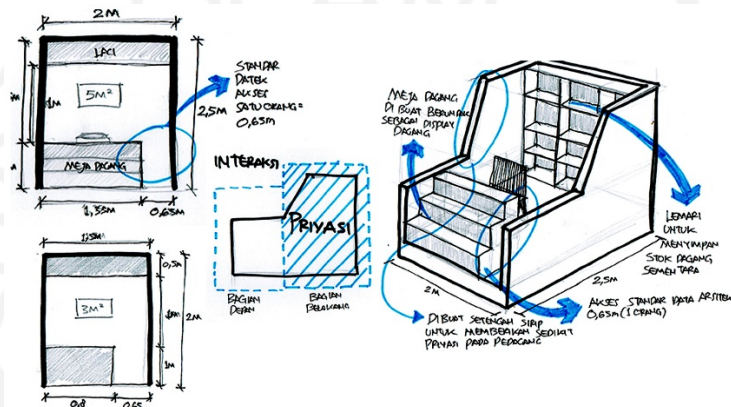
66 Modul Ruang Dagang pada Pelapak
